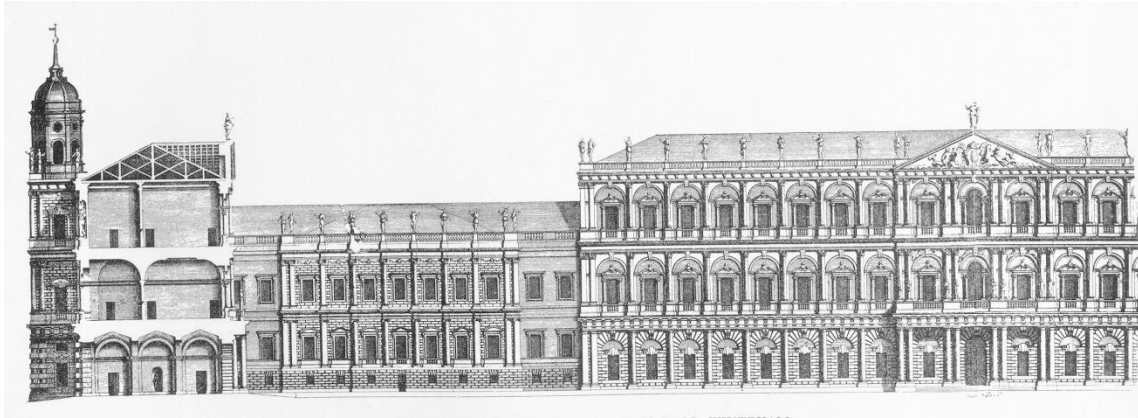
Inigo Jones, *Banqueting House*, Entwurf, Situierung am *Whitehall Palace*, Whitehall/London, 1619 – 1622
